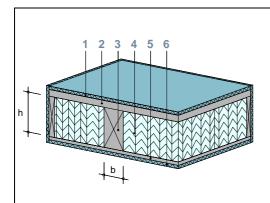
Passage de la conduite à travers les éléments de construction RF1
